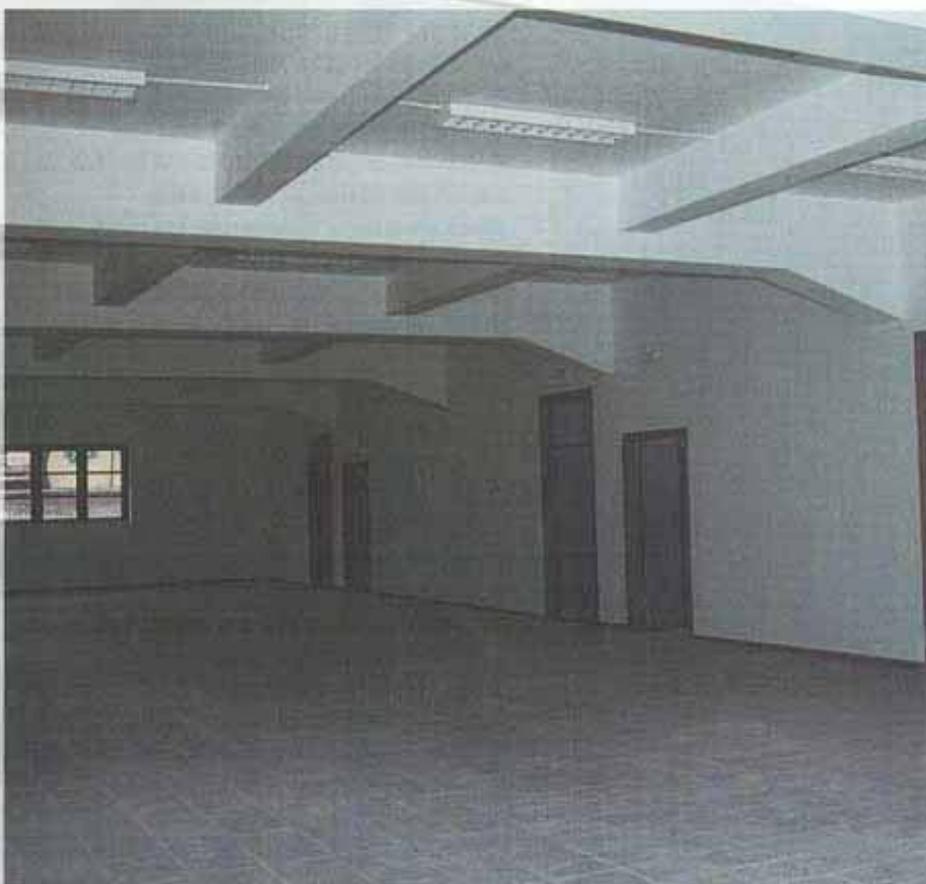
Applicazione sull'intradosso delle lamine CARBOPLATE, a interasse corrispondente alla nervatura del solaio.
